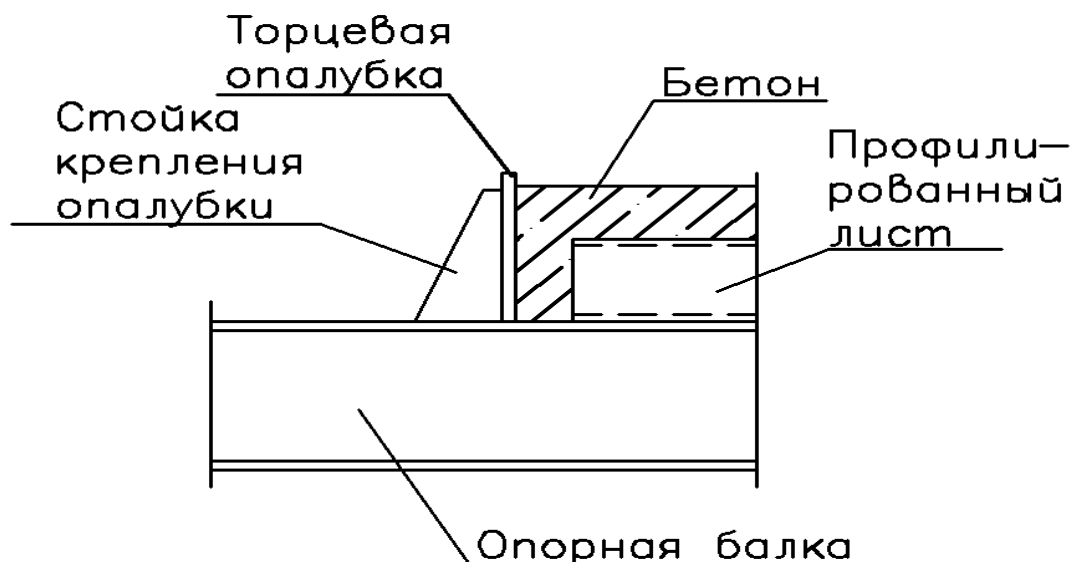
Принципиальная схема торцевой опалубки перекрытия.
